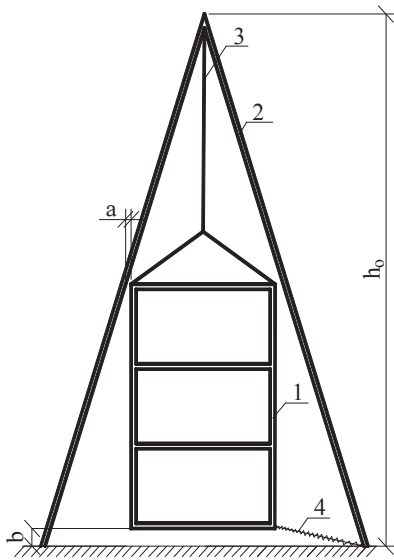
,а. подвесное здание при опирании на пирамидальную раму: 1 – здание; 2- опорная рама; 3 – несущие тросы; 4- предохранитель
